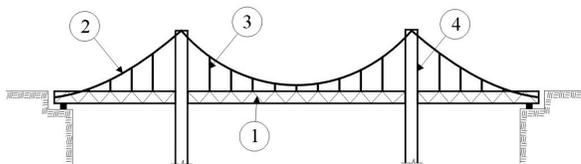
Esquema de uma ponte Pênsil: ① viga metálica; ② cabo portante; ③ pendurais de suspensão de vigamento no cabo portante; ④ torres de apoio do cabo portante.
